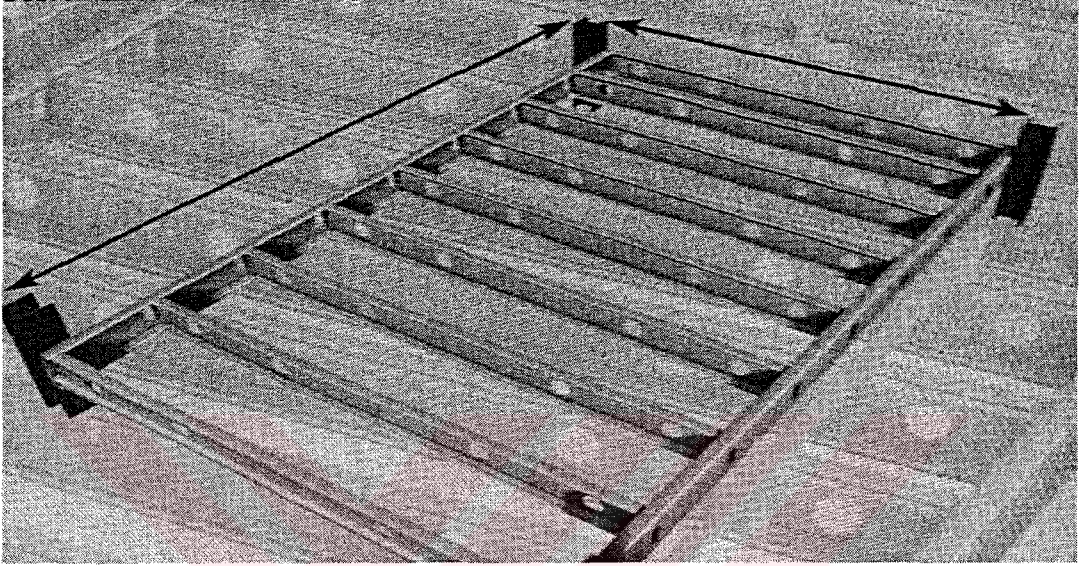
Döşeme kirişlerinin betonarme kiriş üzerinden konsol yapması (NASFA,2000)
